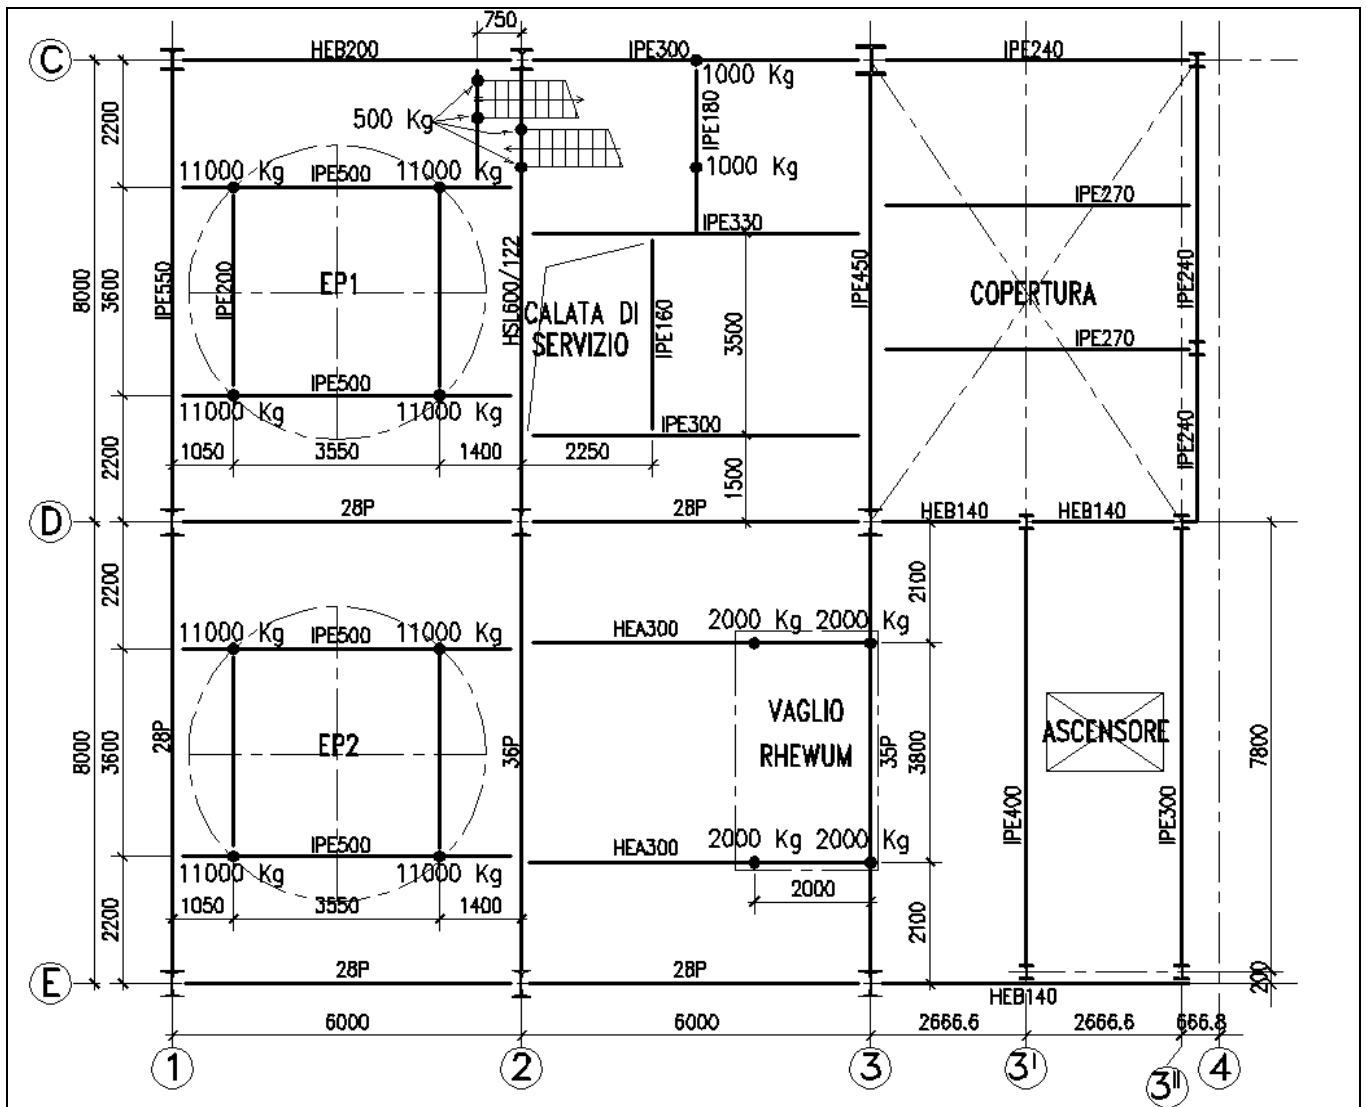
PLANIMETRIA +20.500 - terzo impalcato -
